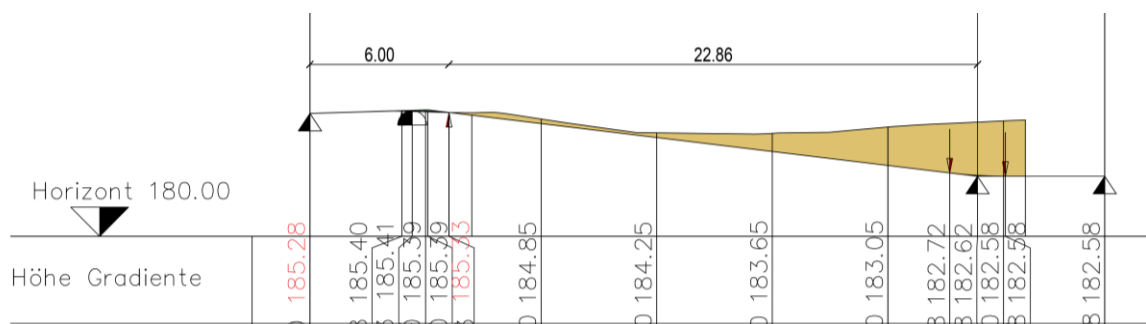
Coupe de principe de la rampe d'accès vers le sous-sol. (Source : BEST)
